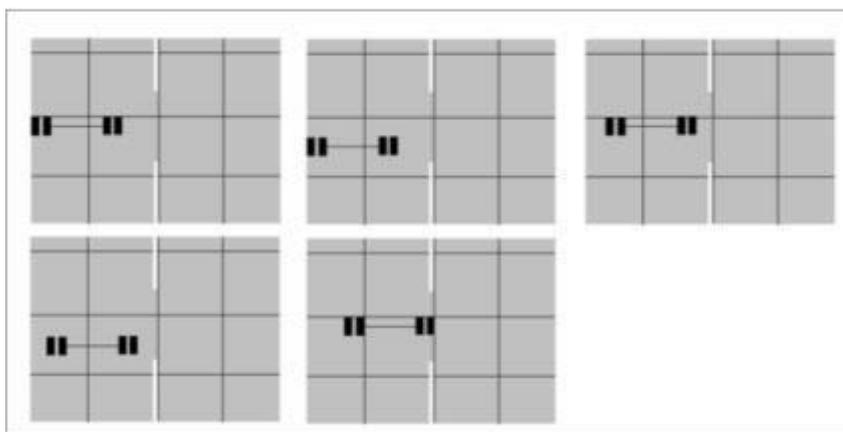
( Fuente: OptiPave 2, TCPavements)
